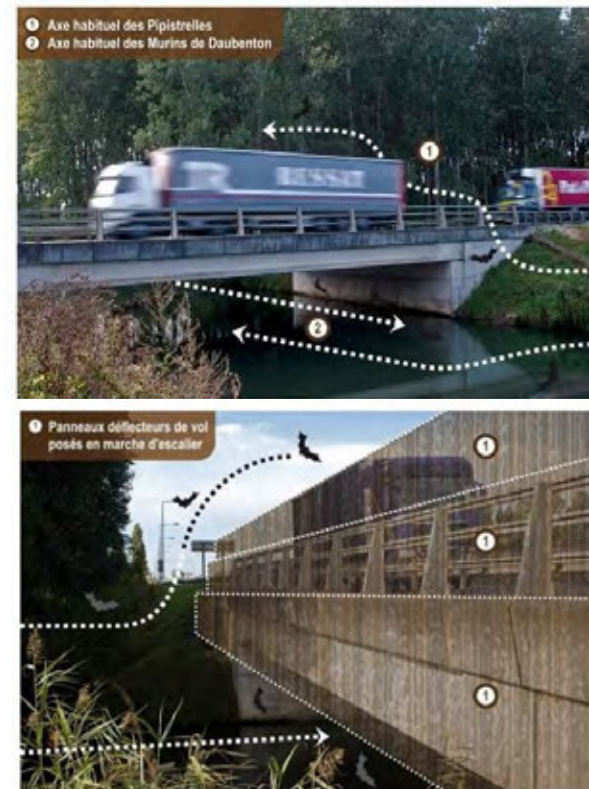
ILLUSTRATION DU RISQUE DE COLLISION POUR LES CHIROPTERES (EN HAUT) ET PROPOSITION DE TYPE D'AMENAGEMENT A METTRE EN PLACE SUR LES OUVRAGES D'ART FRANCHISSANT LES COURS D'EAU [ © BIOTOPE]
